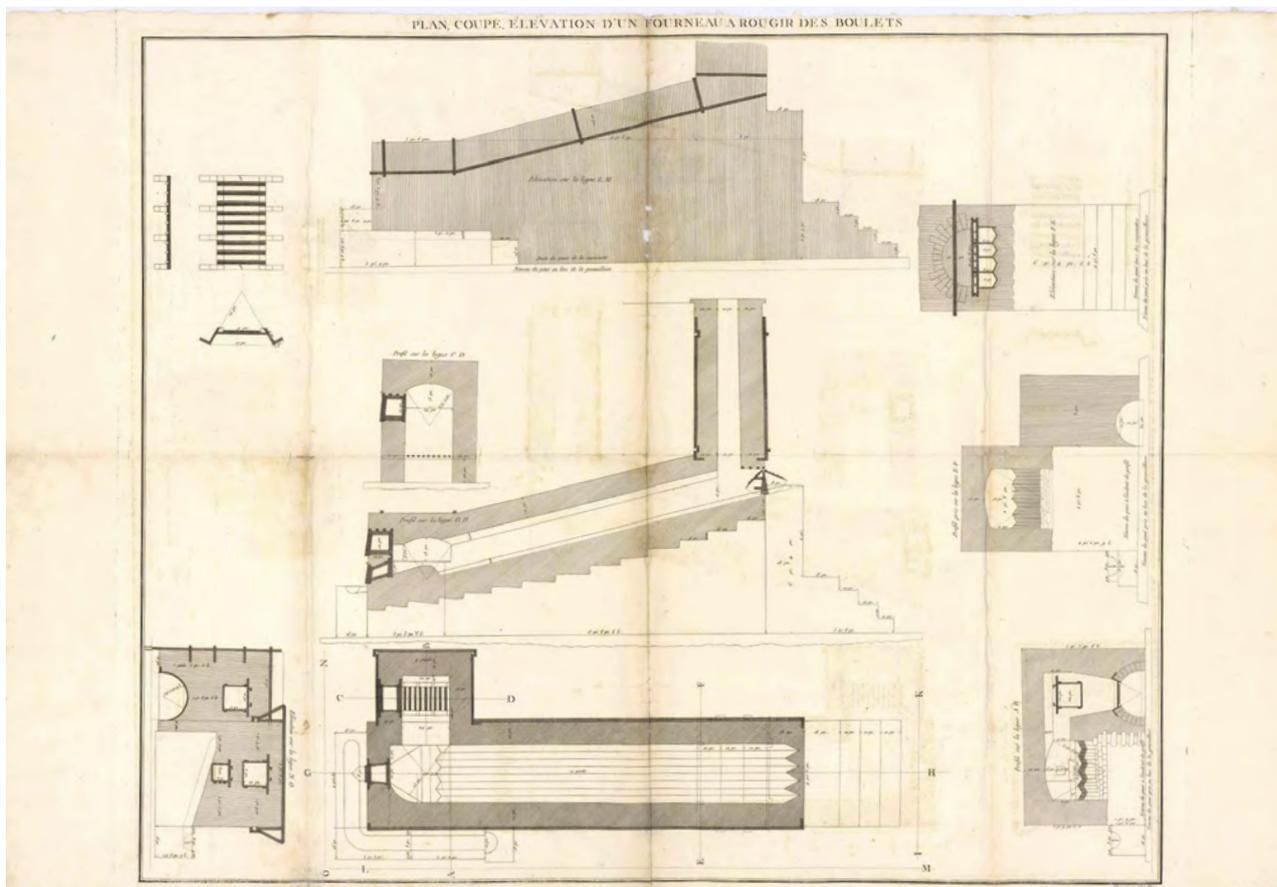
Plan, coupe, élévation d'un fourneau à rougir des boulets (AD 44 L 565-2)
